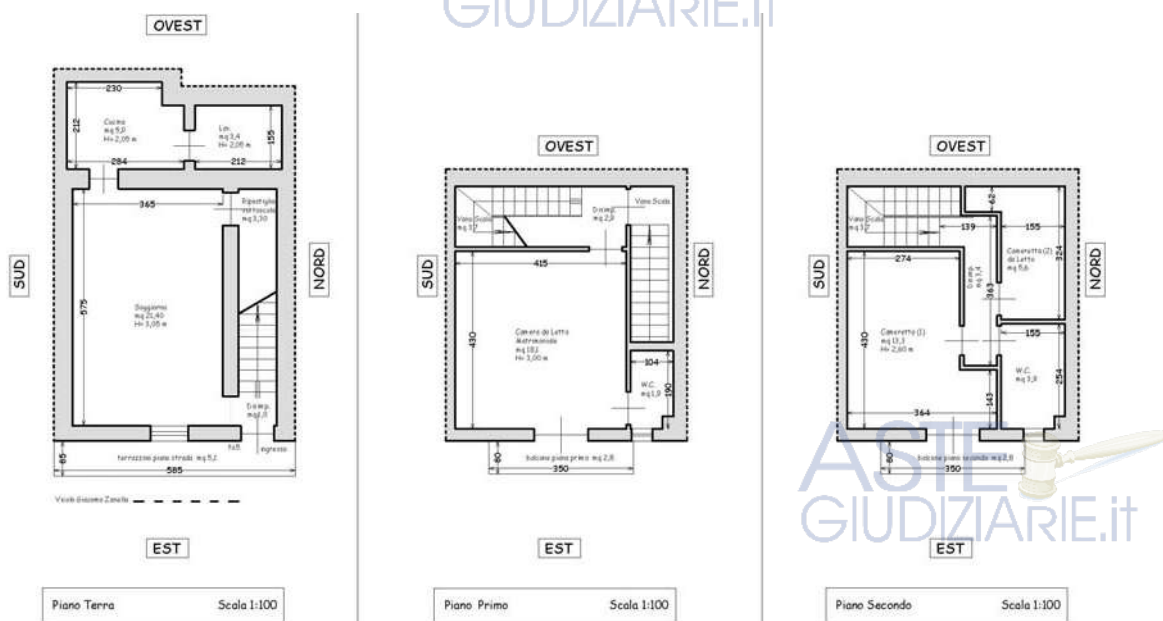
Stralcio piante di rilievo (Immobile piano terra, primo e secondo Fg. 69, part. 13233, sub. 1)
